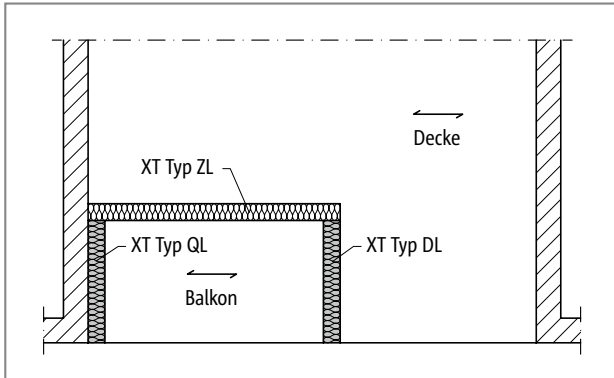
Schöck Isokorb® XT Typ DL, QL: Decke einachsrig gespannt
